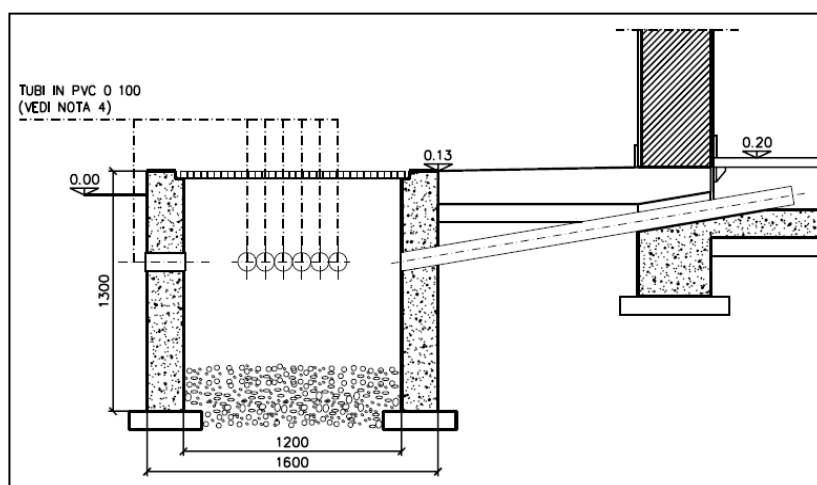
Edificio Tipo B5 – dettaglio attraversamento fascio tubiero
